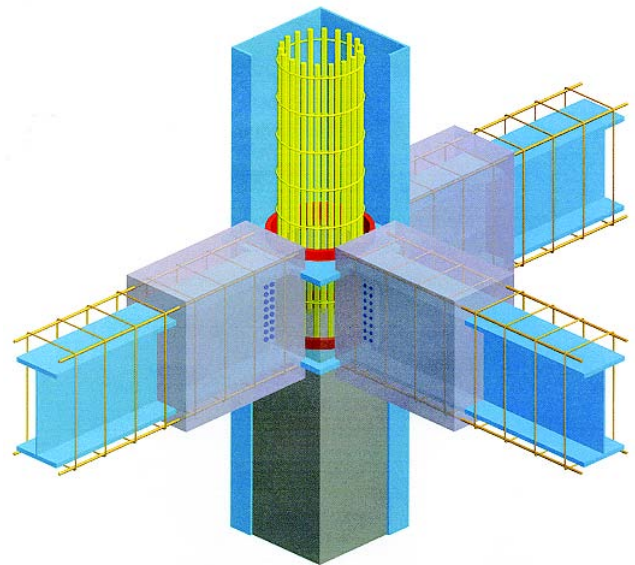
鉄筋内蔵型鋼管コンクリート柱と鉄骨コンクリート梁架構
